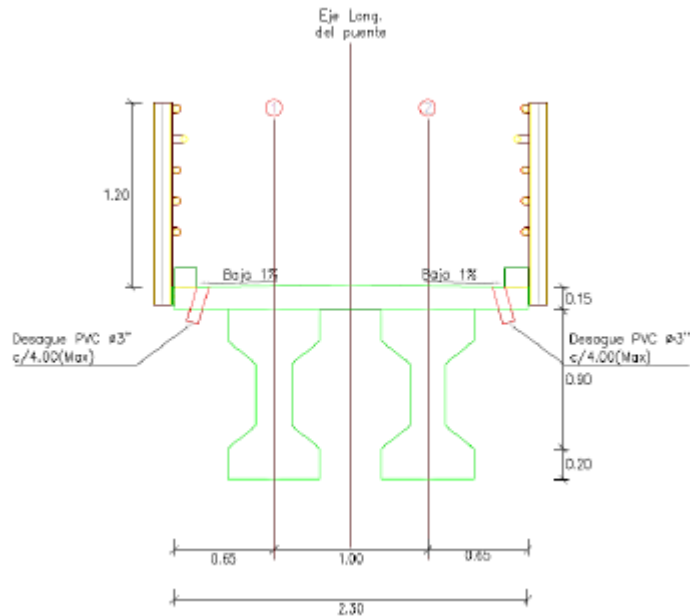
Plano Sección transversal Puente peatonal – Costado Sur
